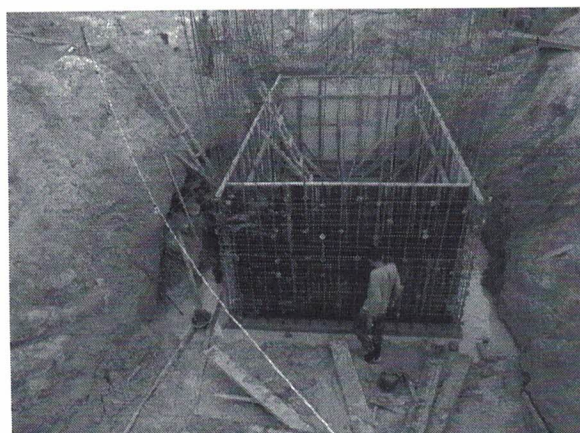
Estação Elevatória de Esgoto Bruto - Poço de sucção.
